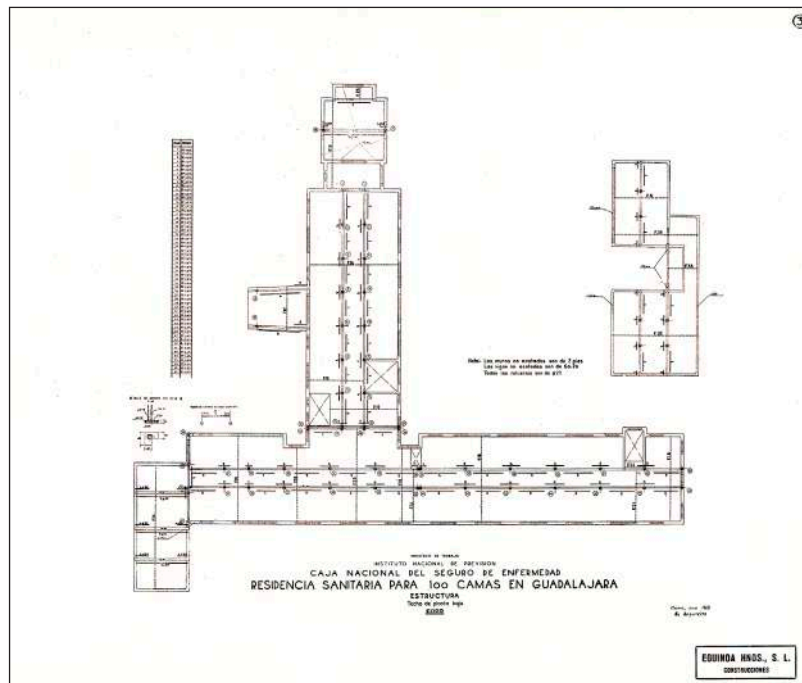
Proyecto Residencia Sanitaria para 100 camas en Guadalajara. Plano estructura techo planta baja. Arquitecto: Fernando García Mercadal, 1948. Colección particular.
